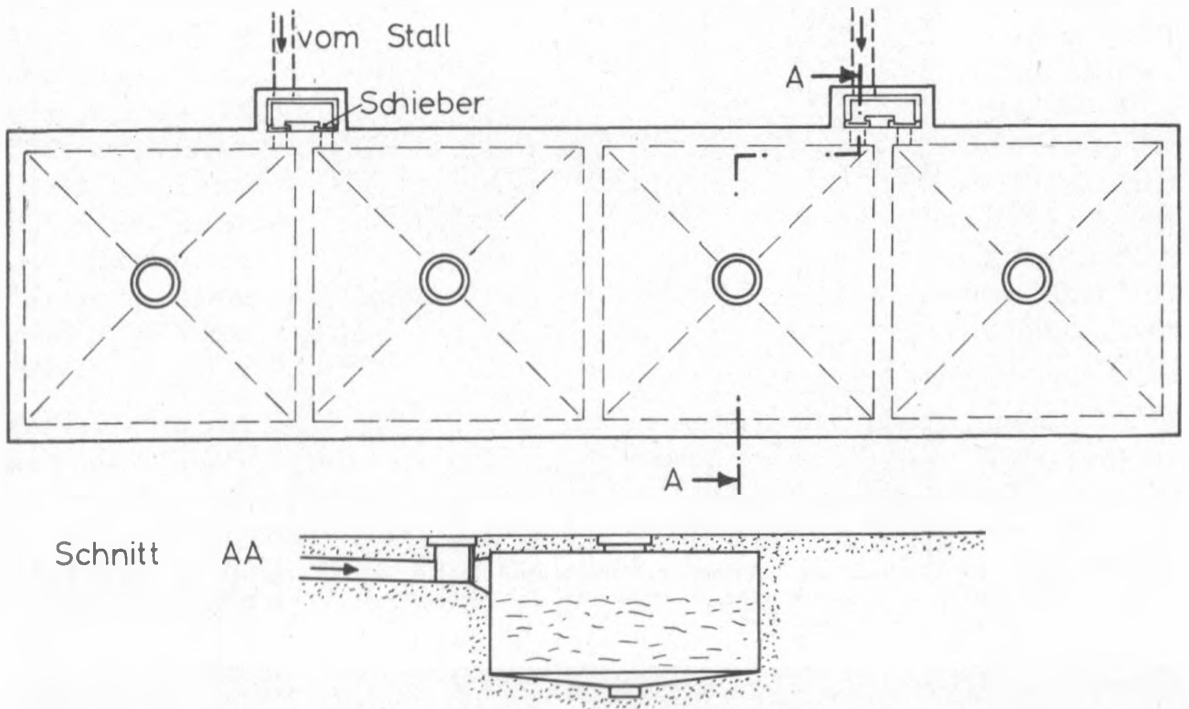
Längsgrube, für das Rühren mit dem Kompressortankwagen in vier Kammern un-
